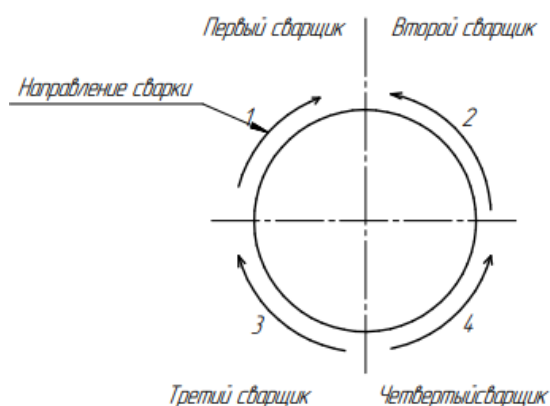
Схема сварки неповоротного кольцевого стыка МГ
